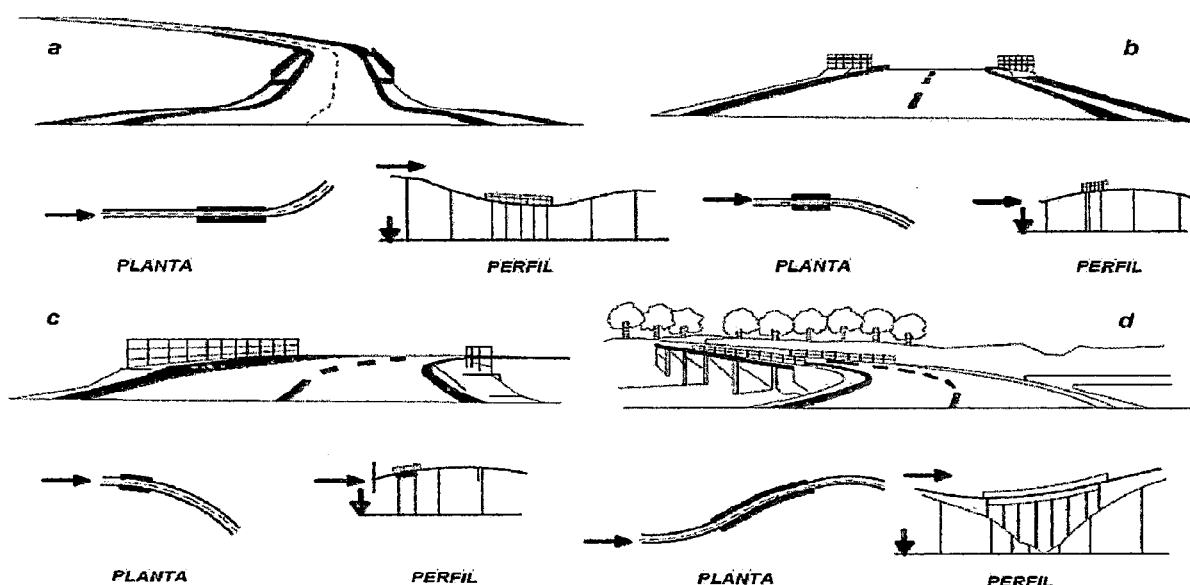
Coordinación del trazo en planta y perfil en estructuras - Fuente[2]
